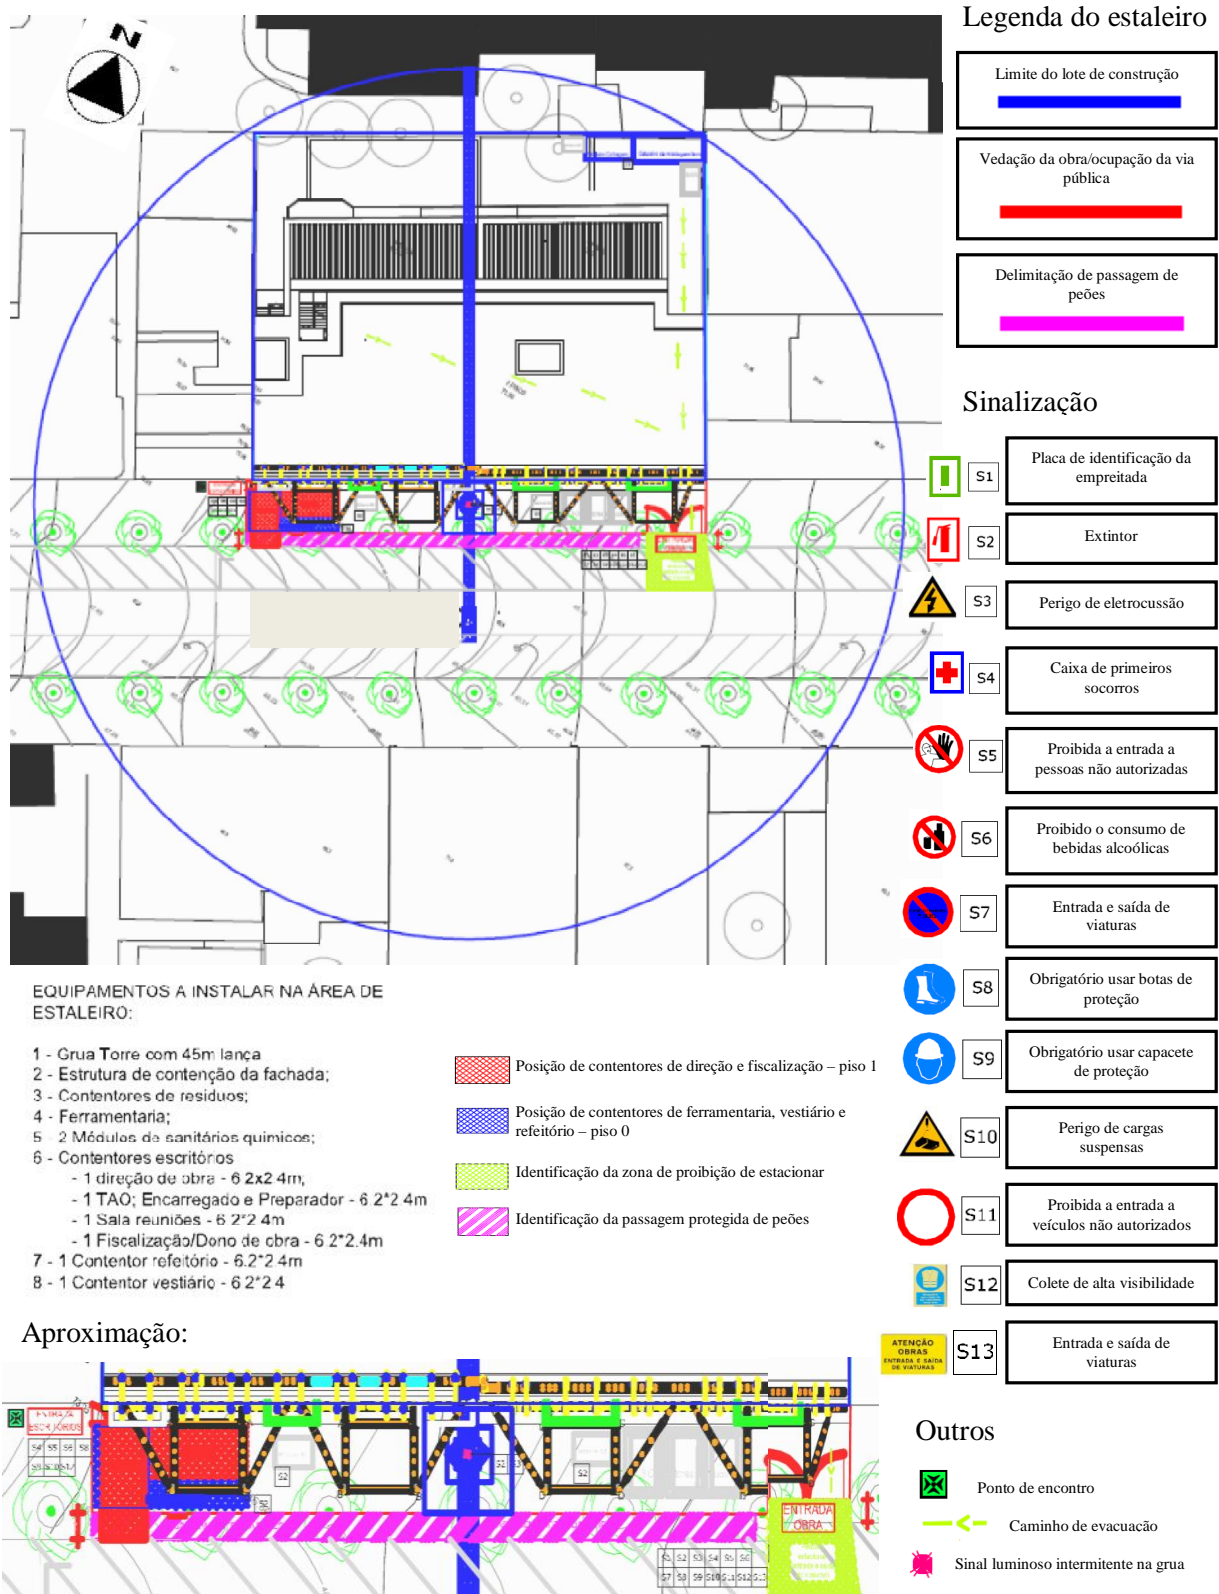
Planta de estaleiro da obra B (sem Escala).
